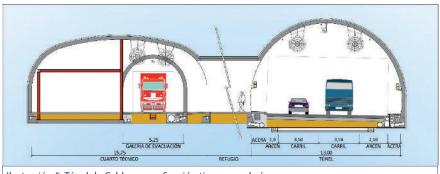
Túnel de Caldearenas. Sección tipo con galería
